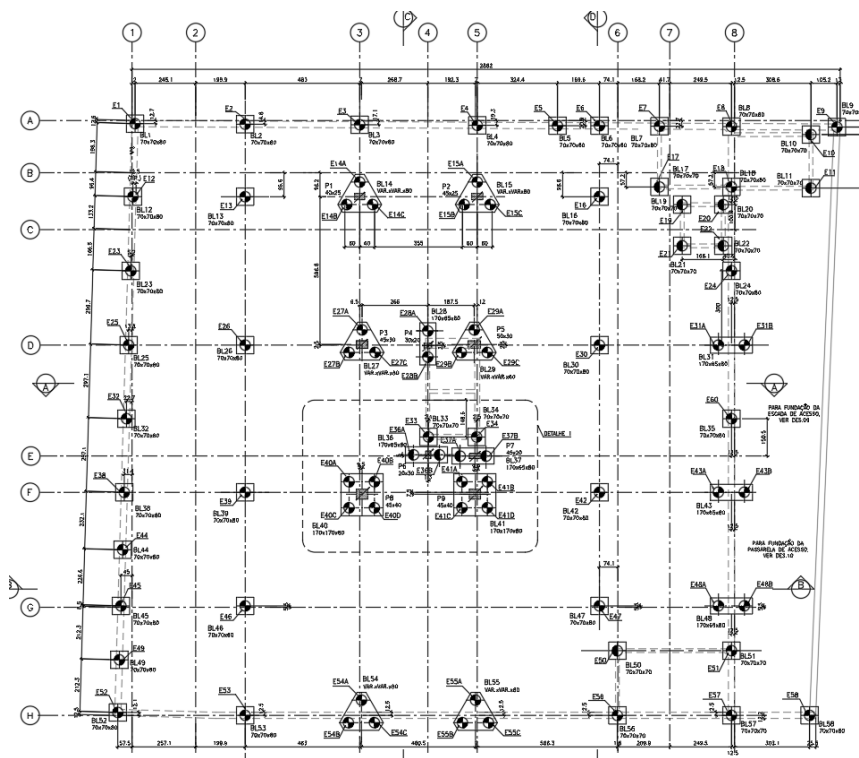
planta da Fundação [desenho código 01-DPSC-PE-EST-PB-01-R01].
